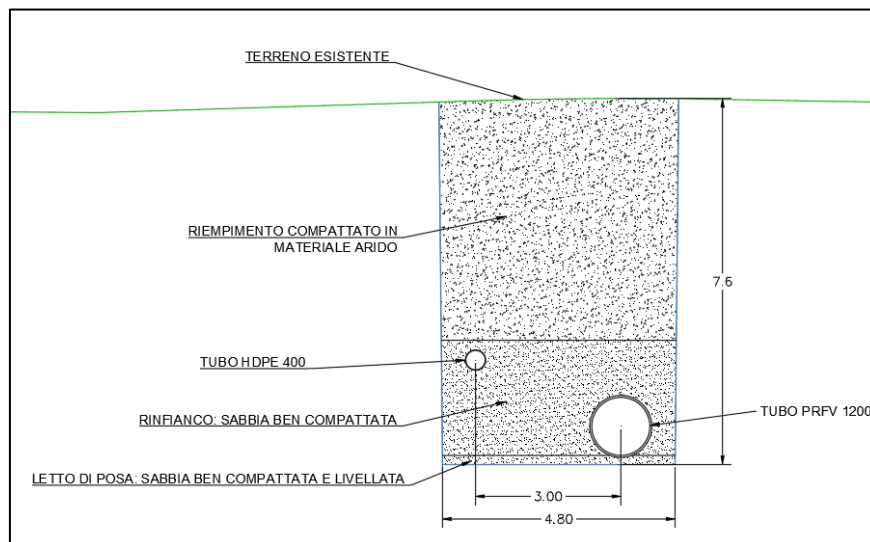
Sezione tipo di posa e scavo a sezione obbligata.
